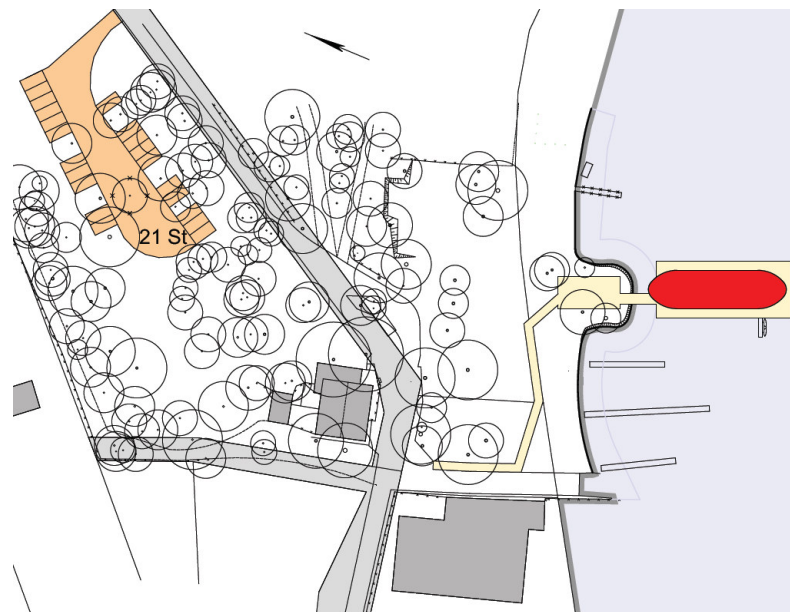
Grundstück des Campingplatzes mit geplanter Seebrücke
